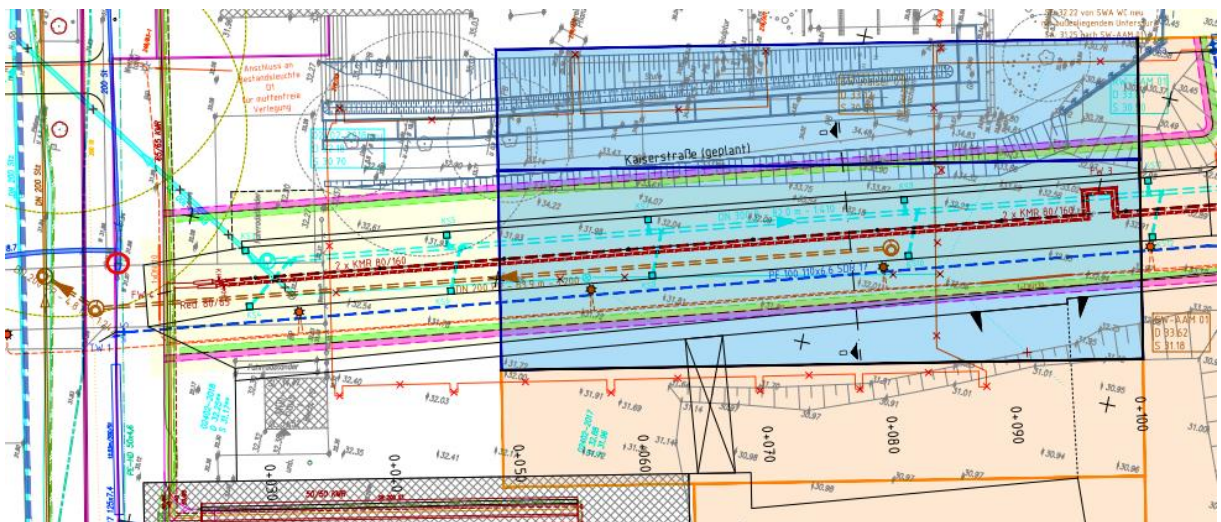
G10.3 Lageplan koordinierter Leitungsplan PM\_LW-Stellen vom 03.06.2019
